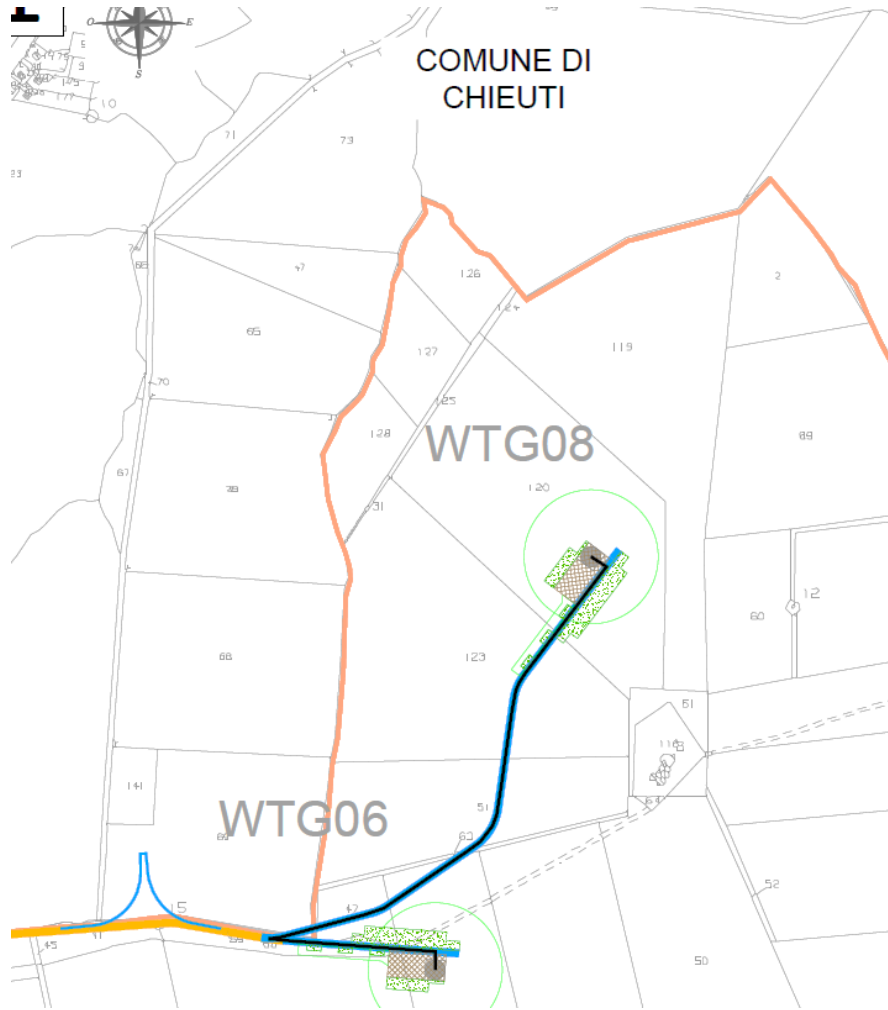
Individuazione area di manovra per aree temporanee di cantiere ricadente in Comune di Chiecti
